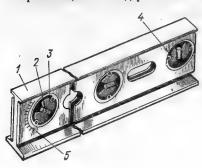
1 — барабан; 2—нить; 3 — отвес; 4 — скоба; 5 — фиксатор барабана; 6 — ручка
